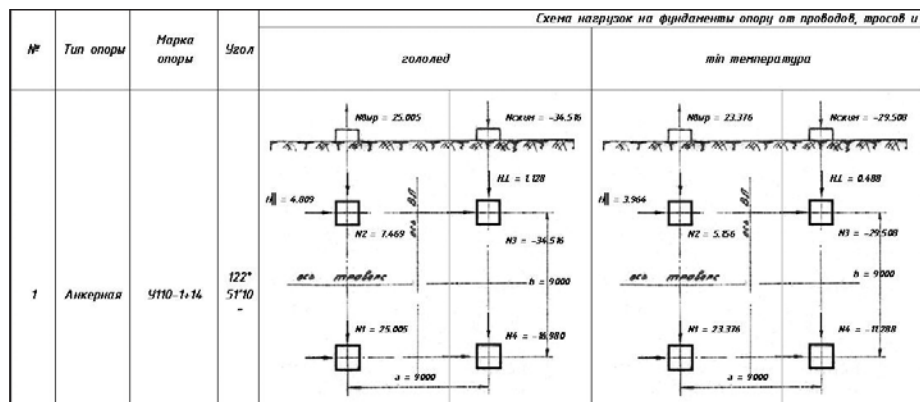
Схема нагрузок на фундамент с результатами расчета
